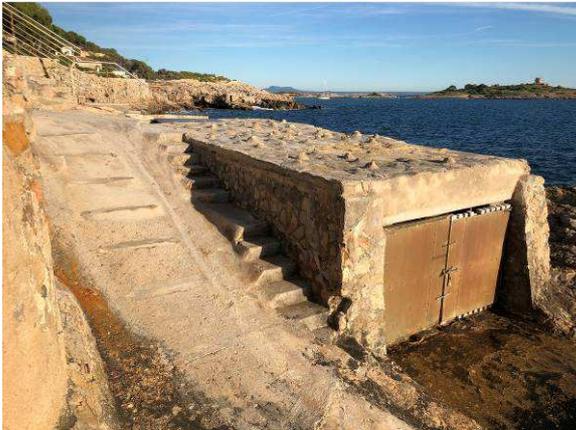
Vista detallada de caseta guardabotes, rampa y escalinata de acceso
